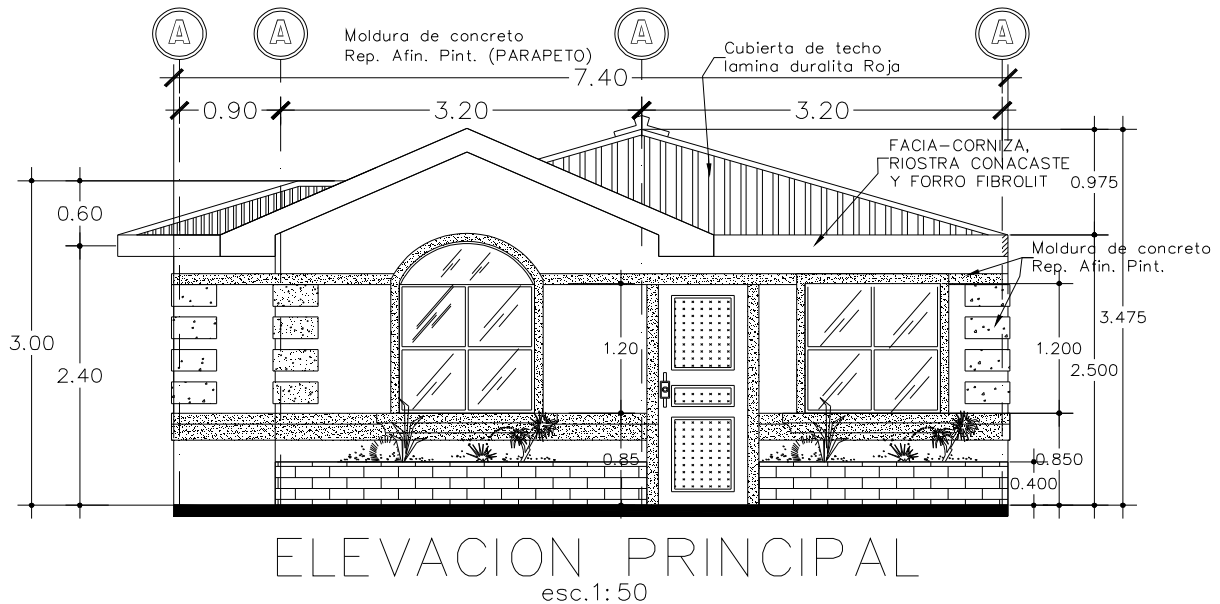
secciones y elevaciones transversales; fig. 2.10 fachada principal.
